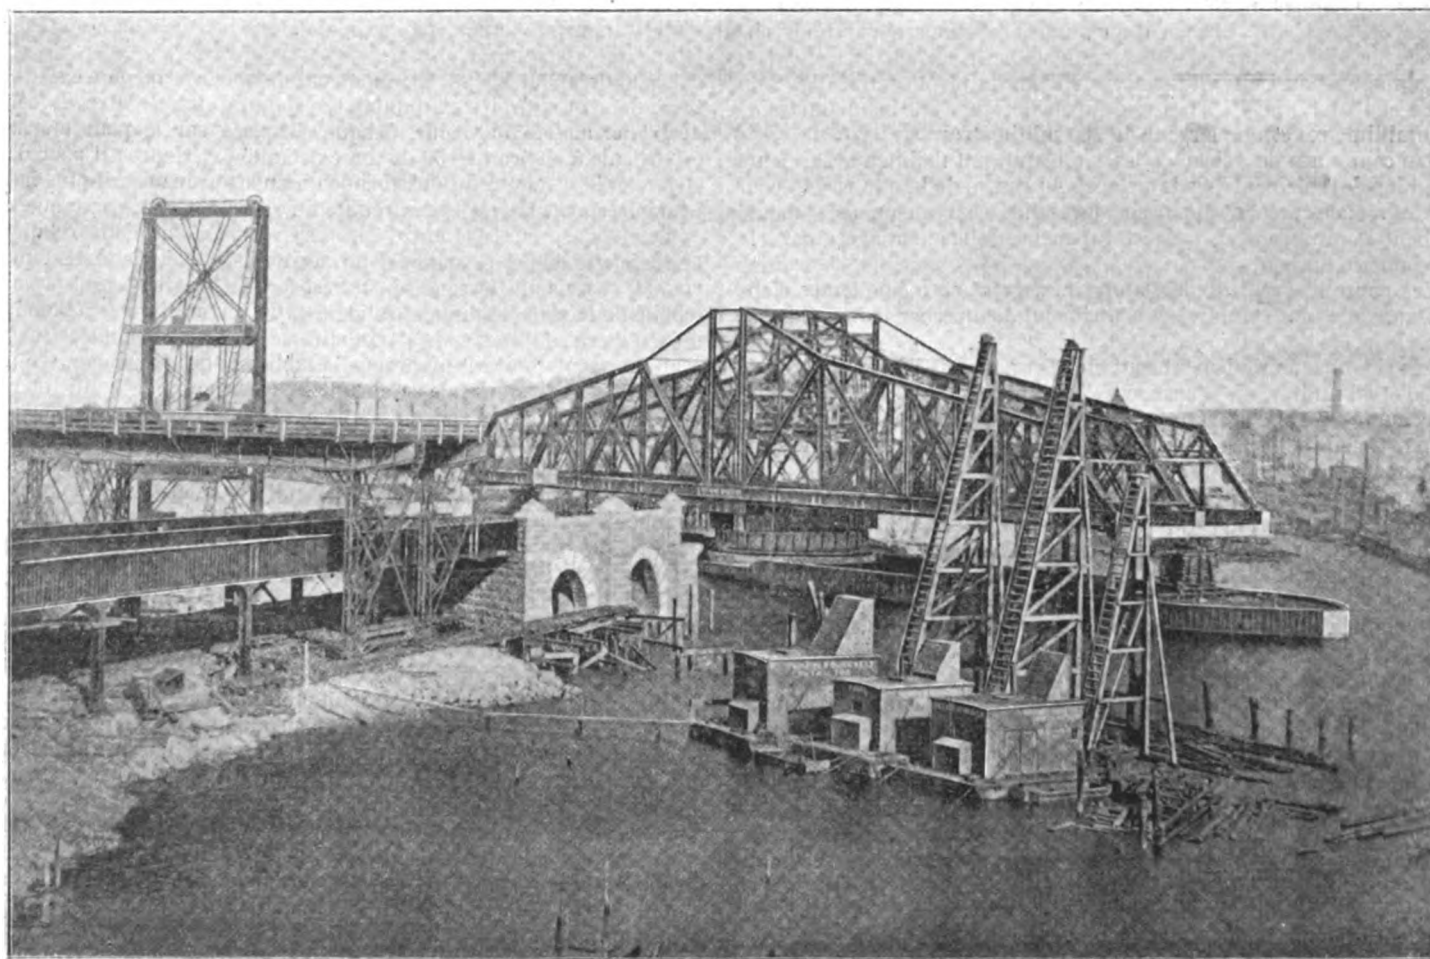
PONT TOURNANT SUR LA RIVIÈRE DE HARLEM, A NEW-YORK : Vue perspective du pont ouvert.
